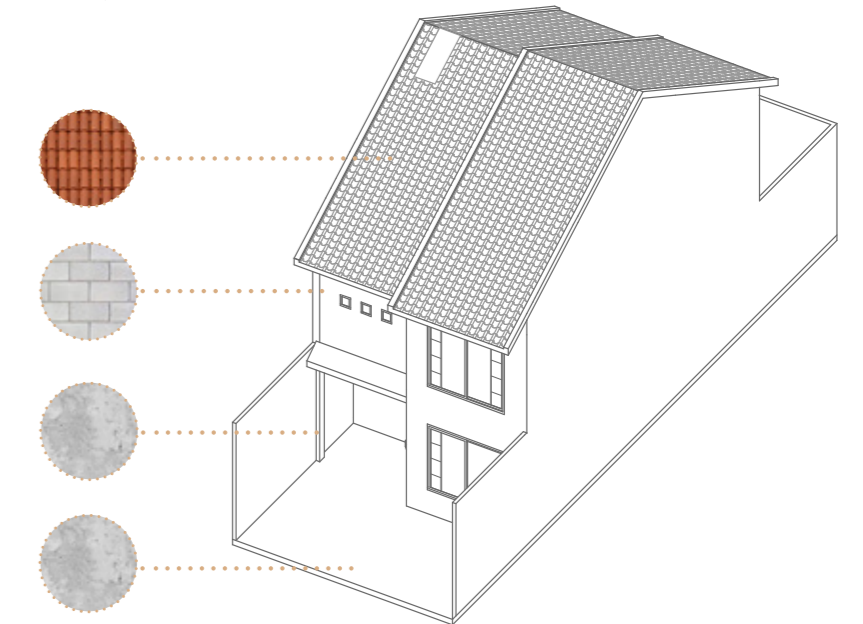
Elementos Constructivos, Vista al Río. Fuente: Autores, 2023
